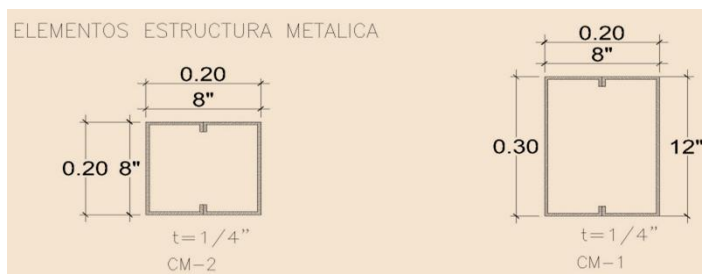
Detalle de las columnas metálicas propuestas.
